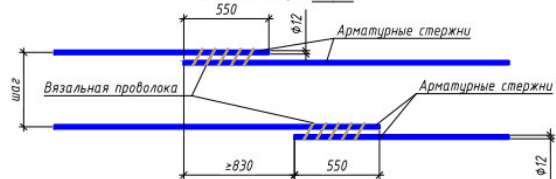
Схема устройство нахлёста стержней арматуры
